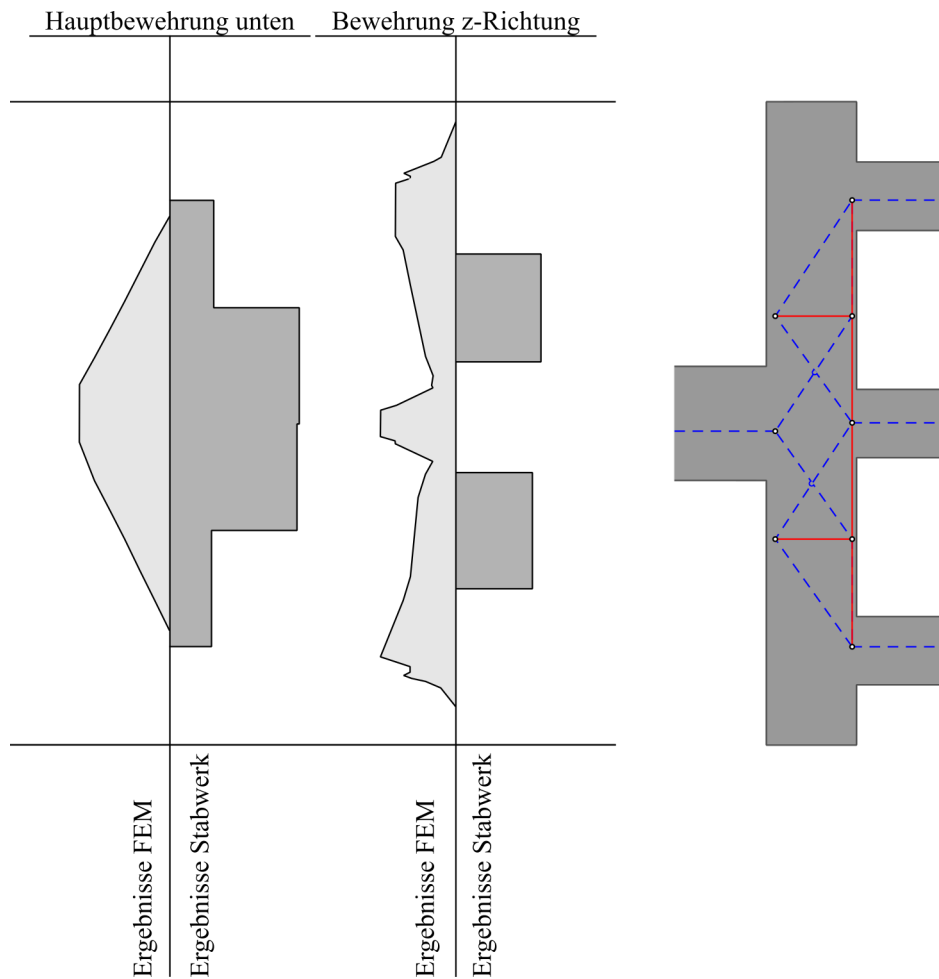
Variante 4 Lastfall 1-Bewehrungsvergleich
